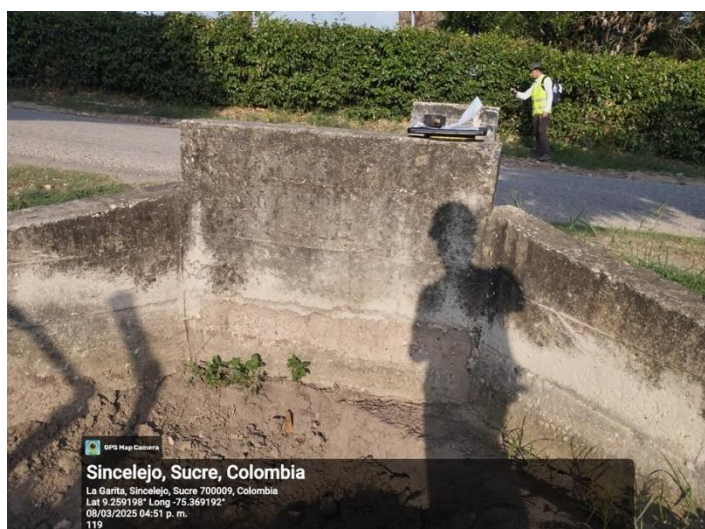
Mantenimiento inadecuado, Alcantarilla totalmente tapada. Alcantarilla. K9+414. Fuente Inspección en la vía
